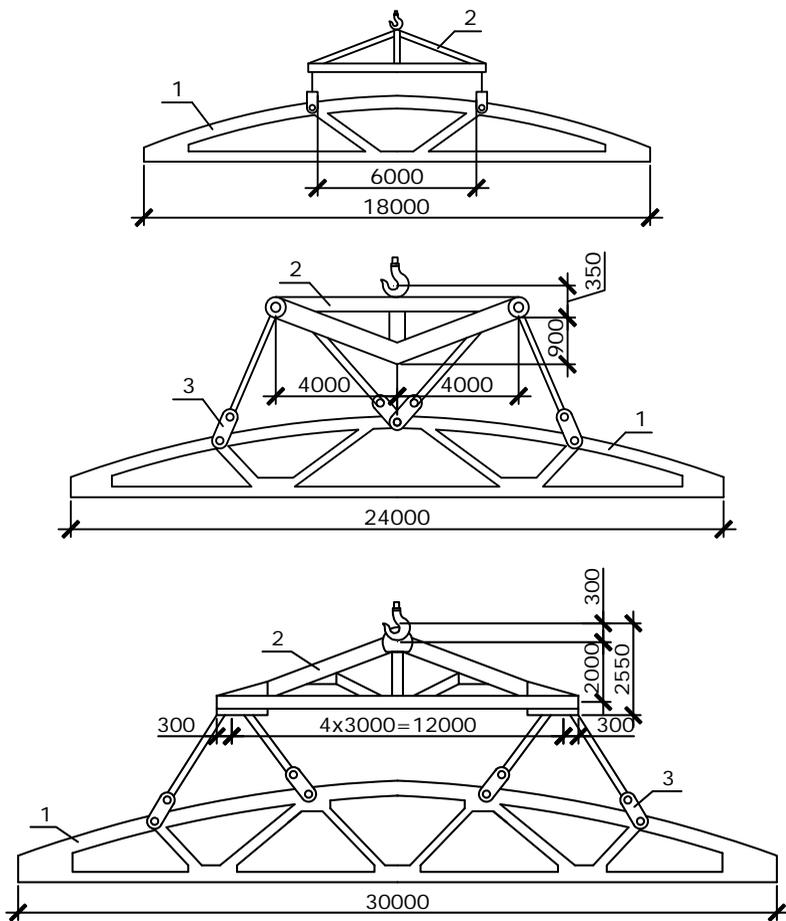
Строповка железобетонных ферм с помощью траверс:
